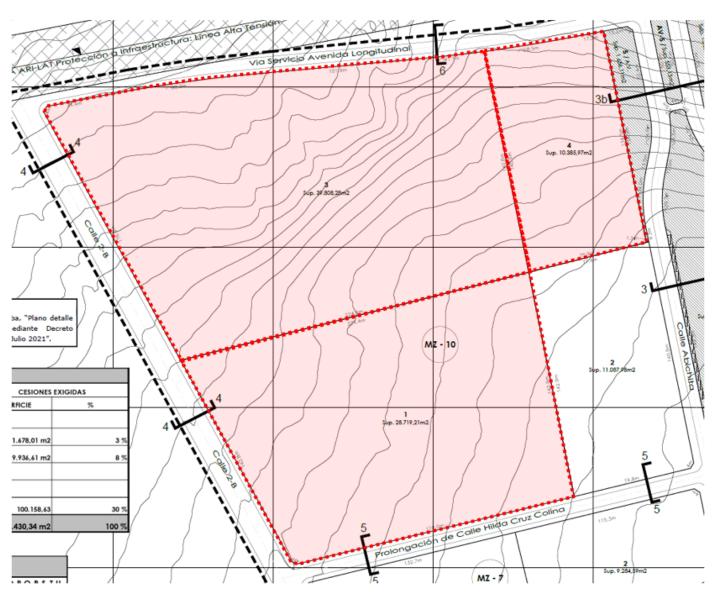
Ubicación Lotes 1, 3 y 4 de la MZ-10. Fuente: Extracto Plano Anteproyecto de Loteo Etapa II, Seremi MINVU.
